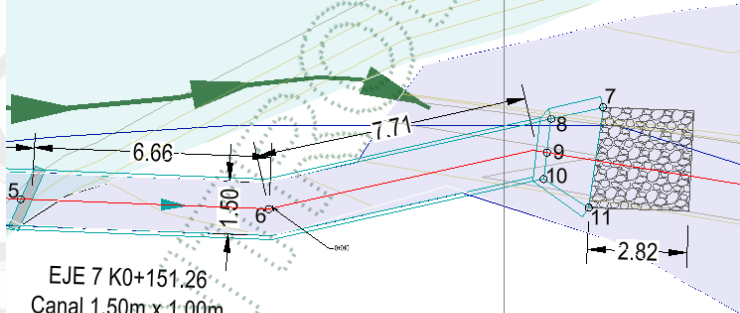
Tipo de la Obra:	Box Coulvert 11
